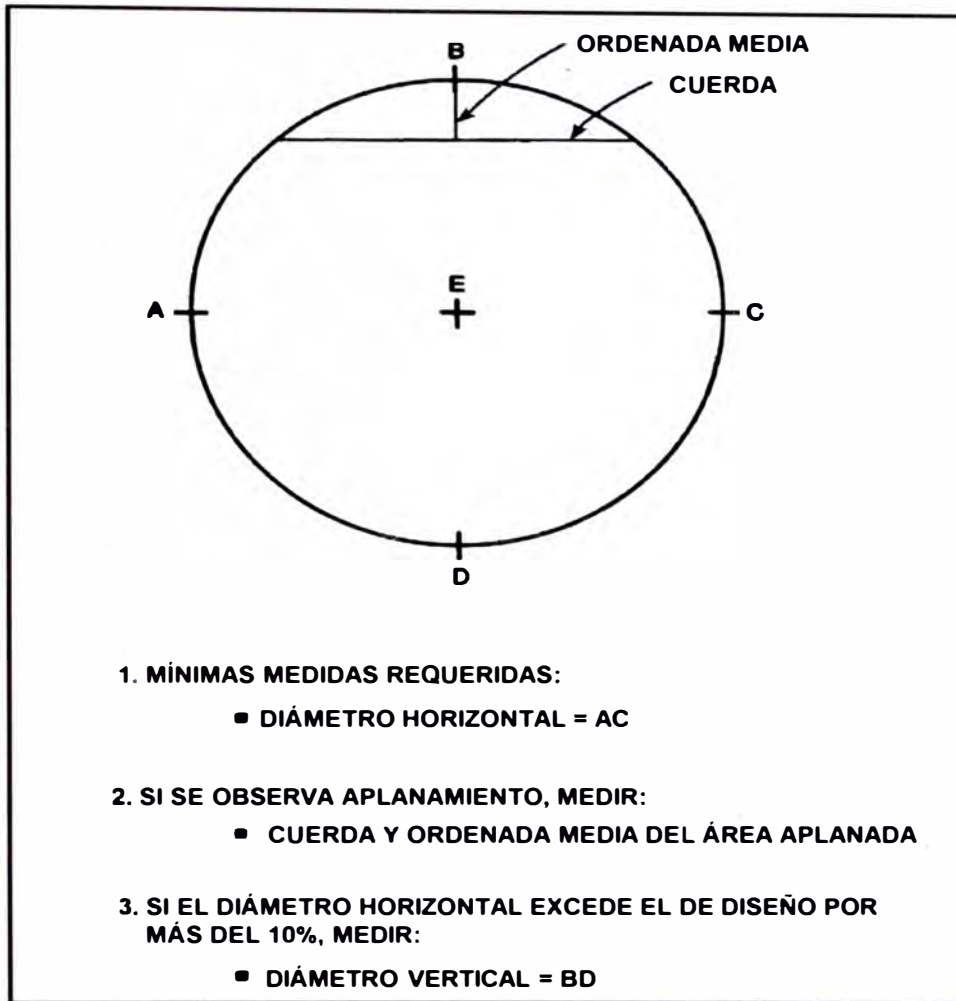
Inspección de la forma para alcantarillas circulares.
